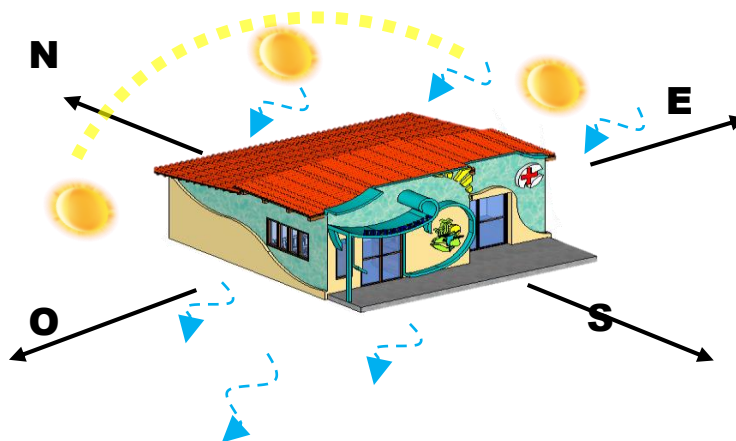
Ventilación e Iluminación. Enfermería
